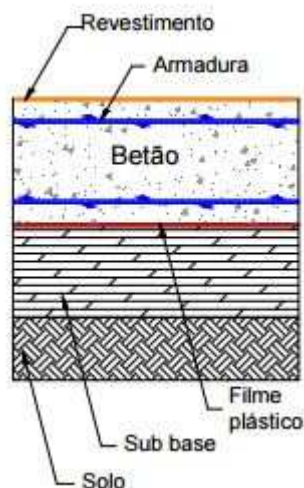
Constituintes pavimento industrial [Adaptado 8]
